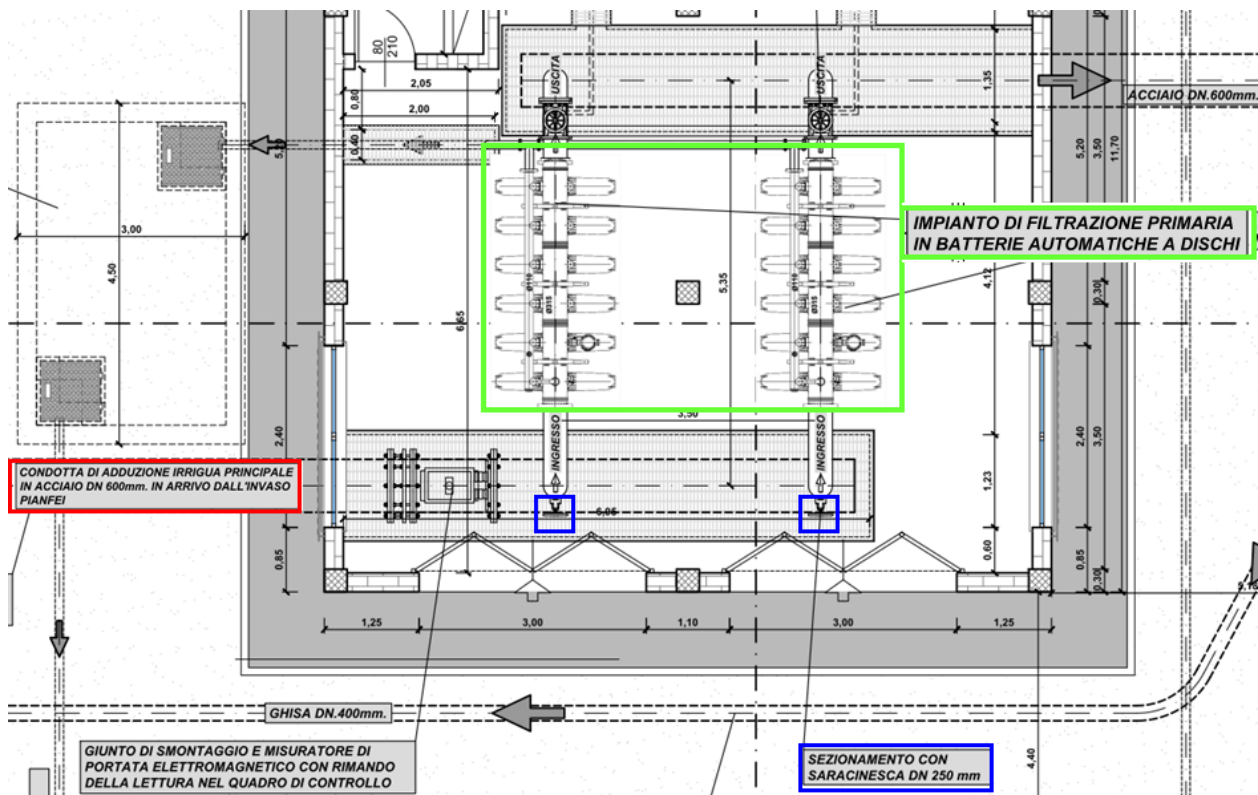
Particolare della pianta dell'edificio filtri e controllo irriguo con evidenziazione della condotta primaria e degli organi di sezionamento. Estratto dall'elaborato grafico N 9 allegato alla documentazione progettuale.
